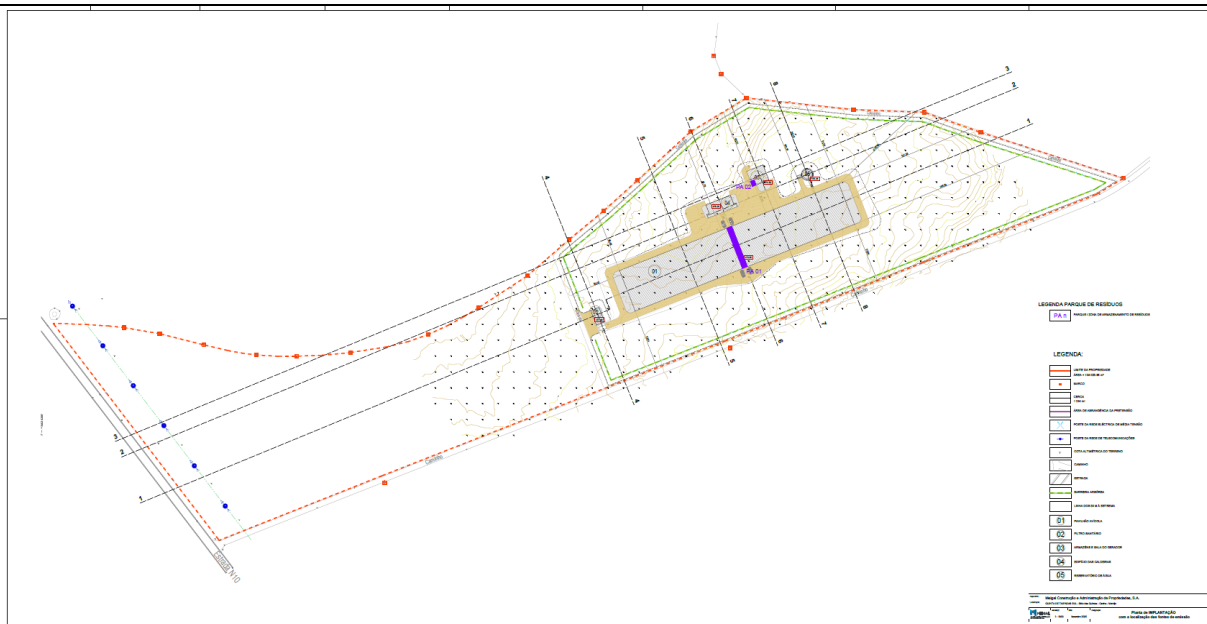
Planta de Implantação - (Fonte Anexo 2, Estudo de Impacte Ambiental (EIA) 2025)
